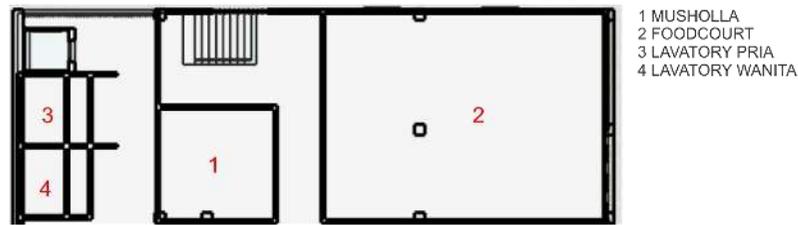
Zonasi Ruang Fasilitas Utama
